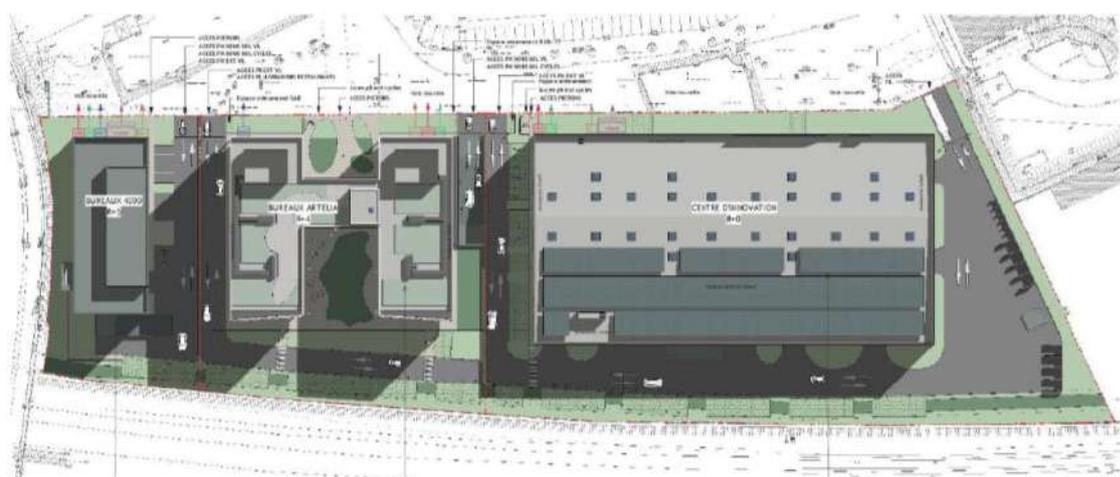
Plan de masse du projet sur le tènement 3 (© SPGA, juin 2020)
